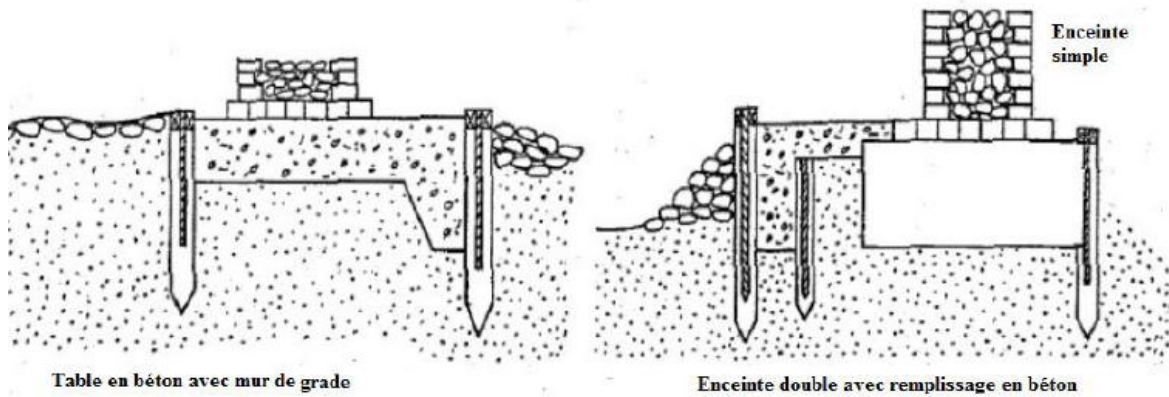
La protection d'un appui par rideaux para-fouilles.
